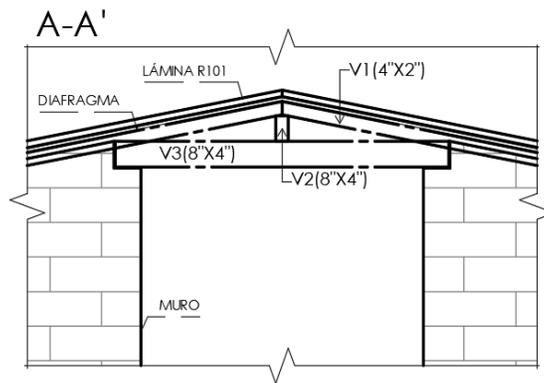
Alzado lateral de la propuesta 2. Imagen propiedad del autor.
